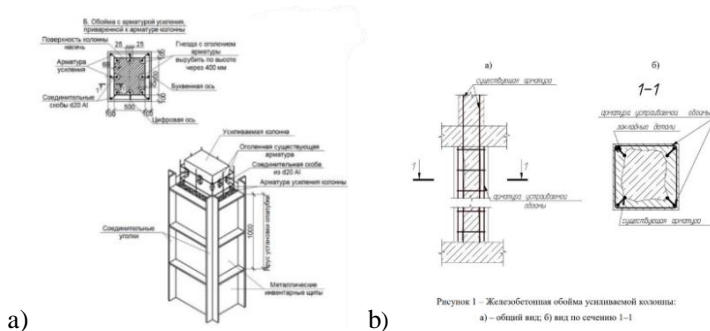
Железобетонная обойма усиливаемой колонны:
